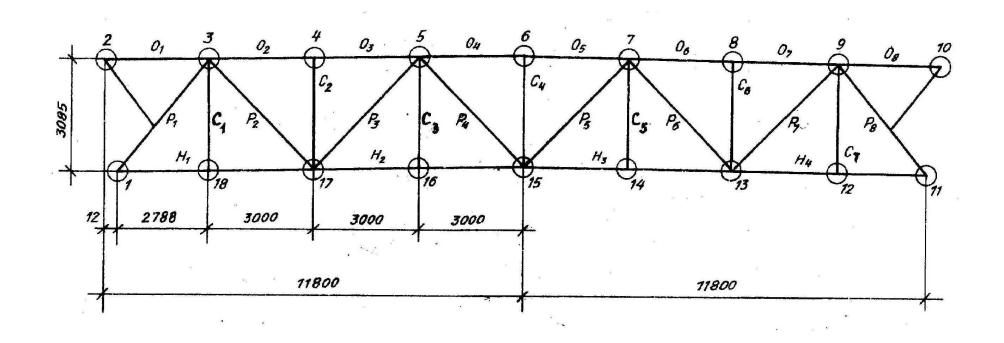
Геометрическая схема фермы ФС-24-3,85 D1; ФС-24-3,85 D2;
